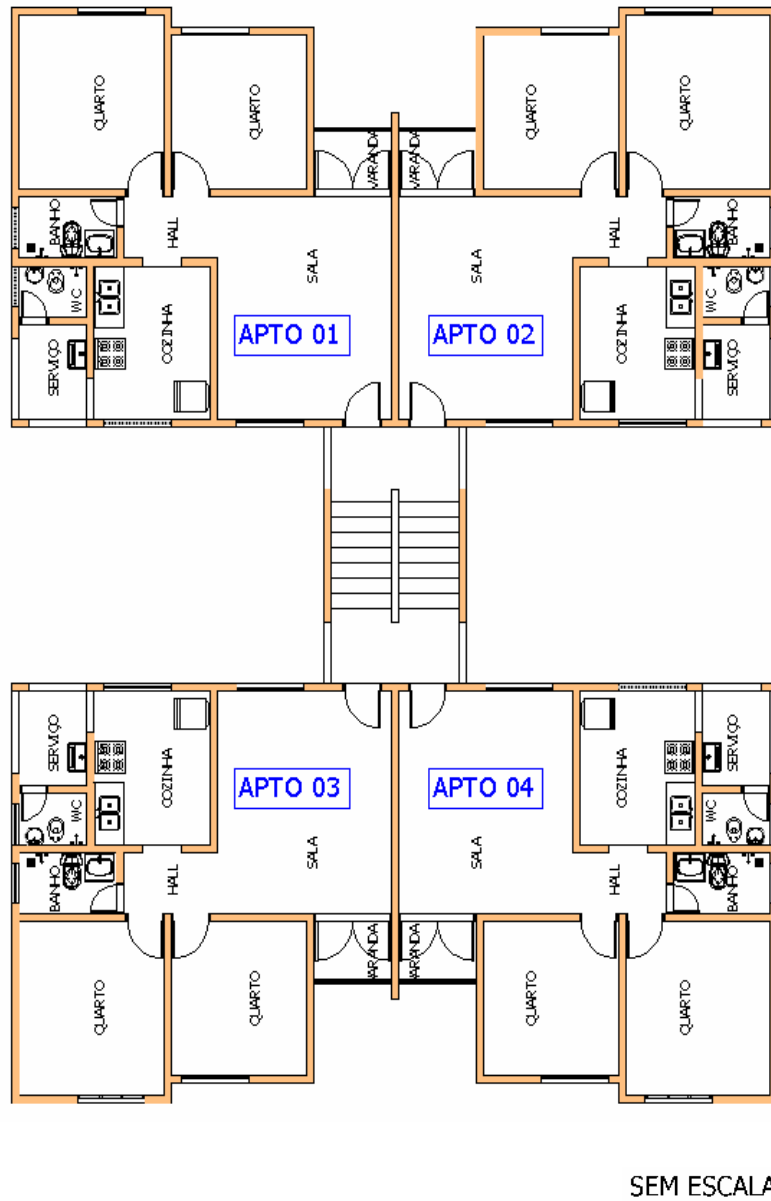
Planta Baixa ilustrativa do nível do Térreo
